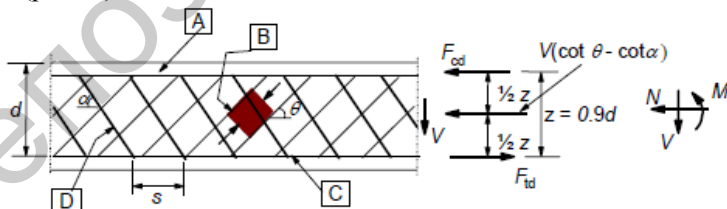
Расчет железобетонных элементов конструкций с поперечной арматурой по ТКП EN 1992-1-1-2009
